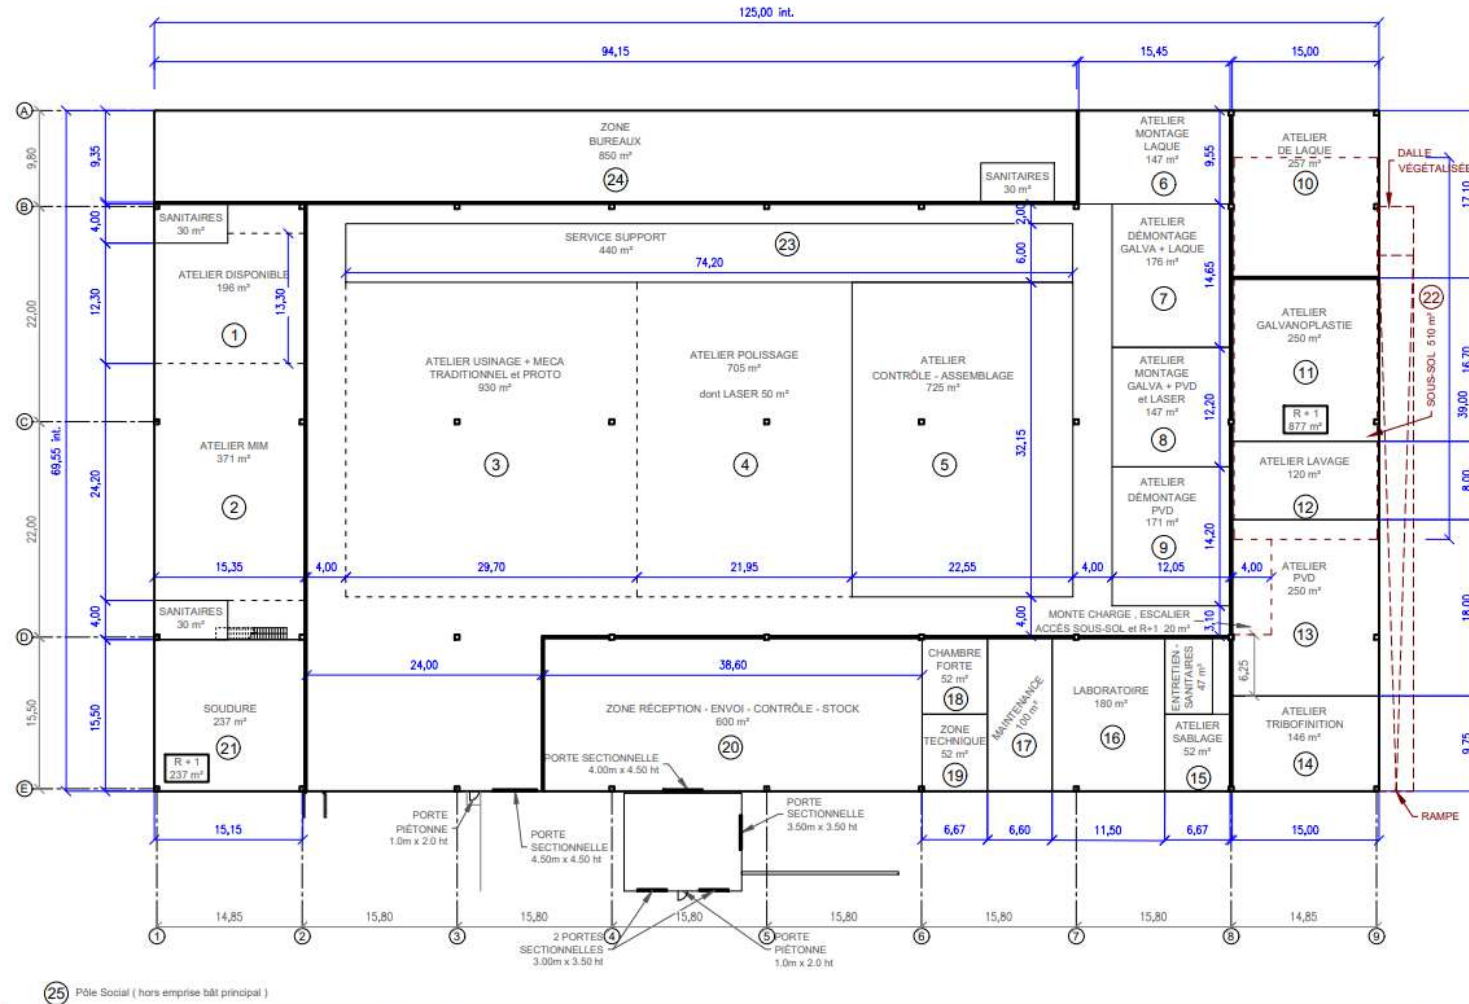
PLAN DE L'IMPLANTATION INTERIEURE
